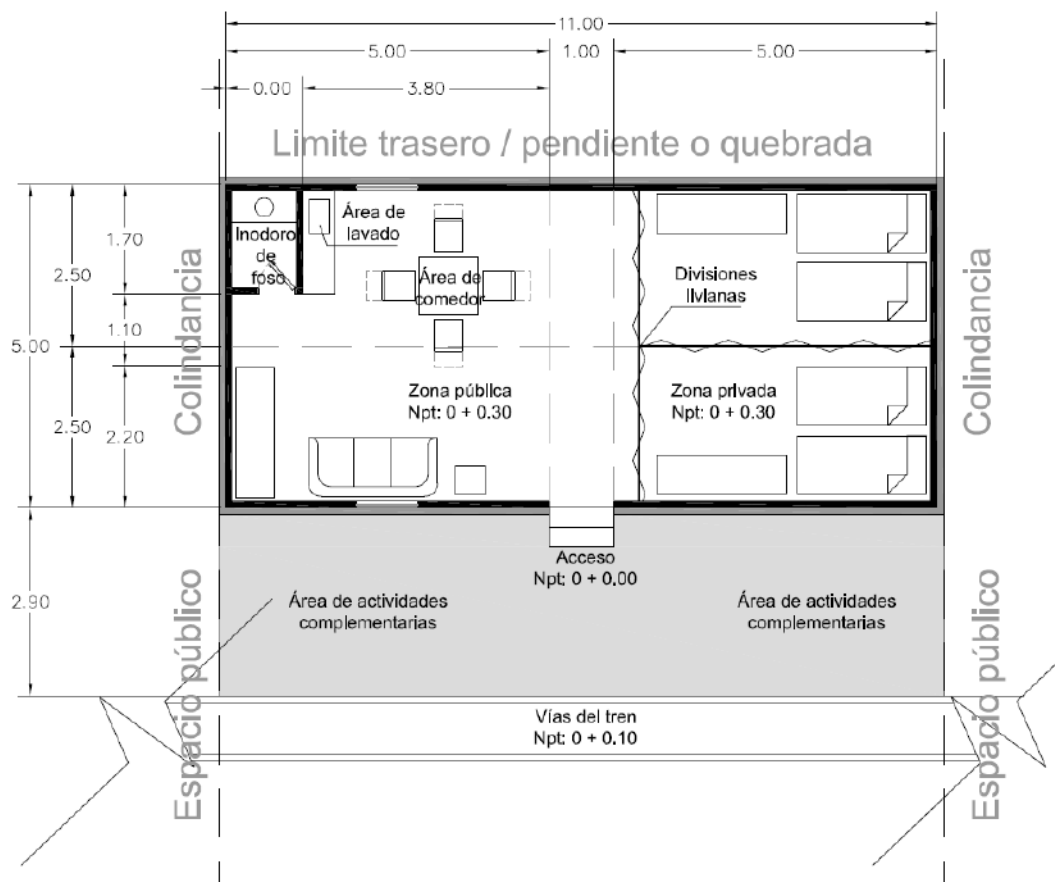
Planta arquitectónica tipo de vivienda en comunidad, sin escala
